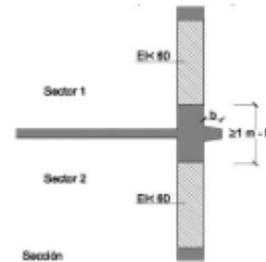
ENCUENTRO FORJADO-FACHADA
